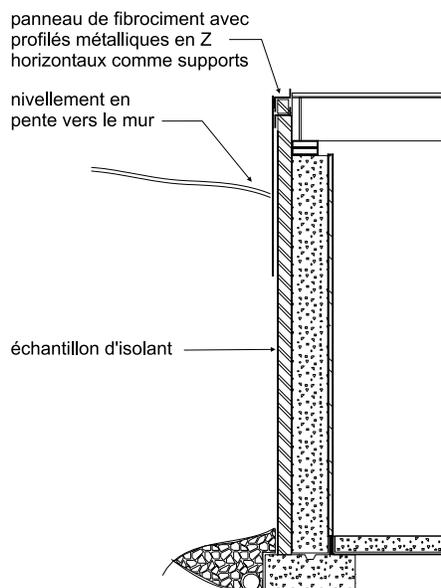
Coupe du mur de sous-sol avec supports horizontaux pour panneau de fibrociment et nivellement en pente vers le mur (mauvais aménagement paysager)
